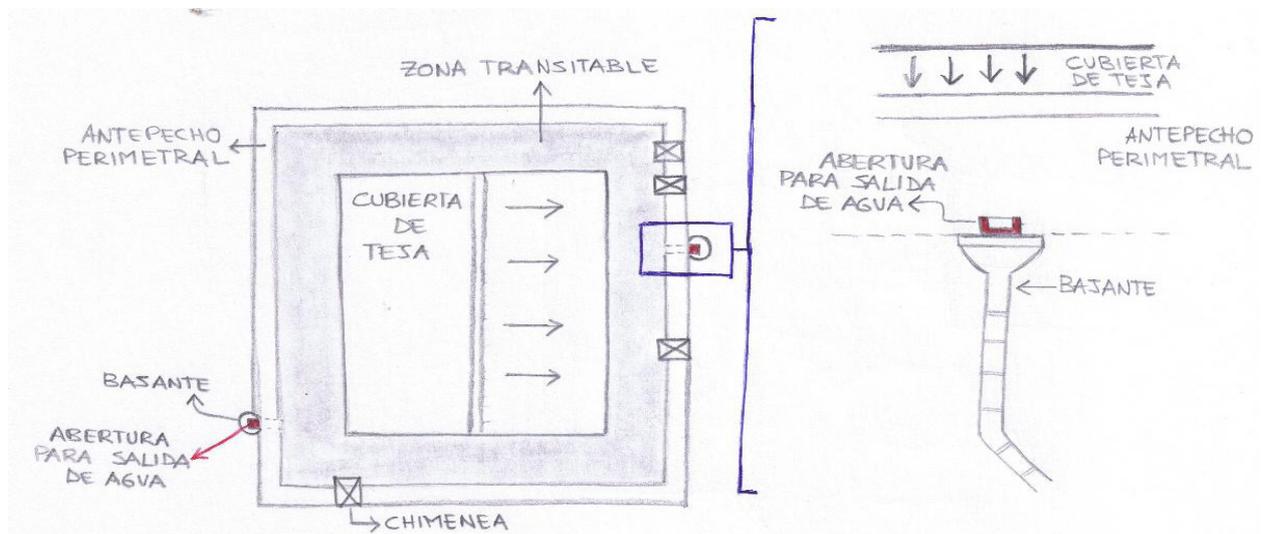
, planta de cubierta de un Lamione y alzado de antepecho y bajante de Lamione (2014). Fuente: Imagen de autor
